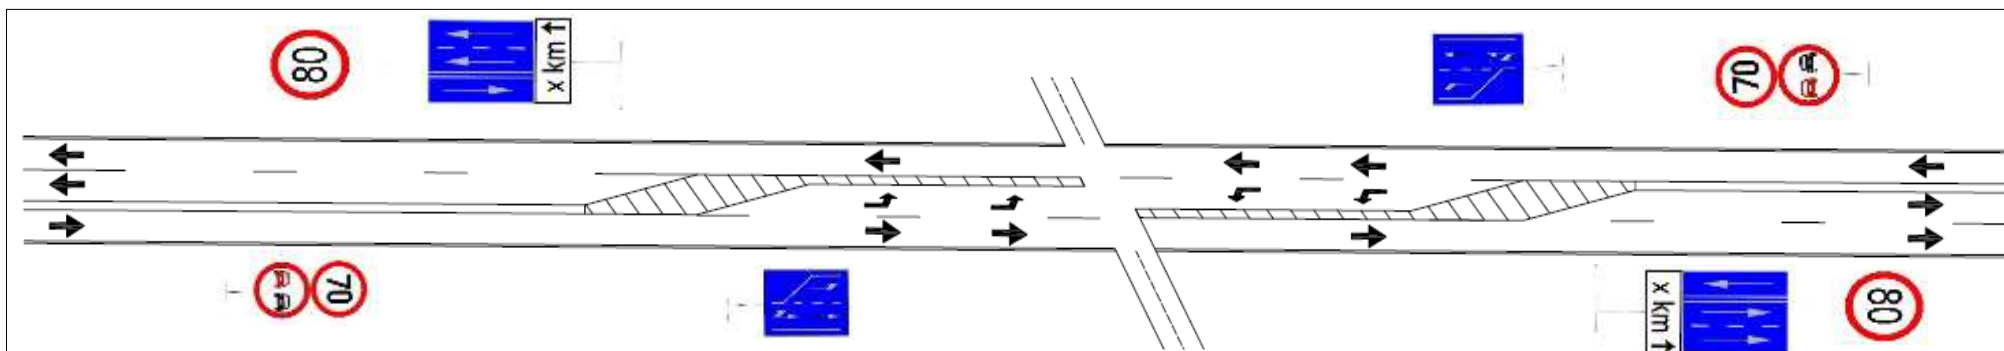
(intersecție cu zonă de alternanță de la 1 bandă pe sens la două benzi pe sens)
